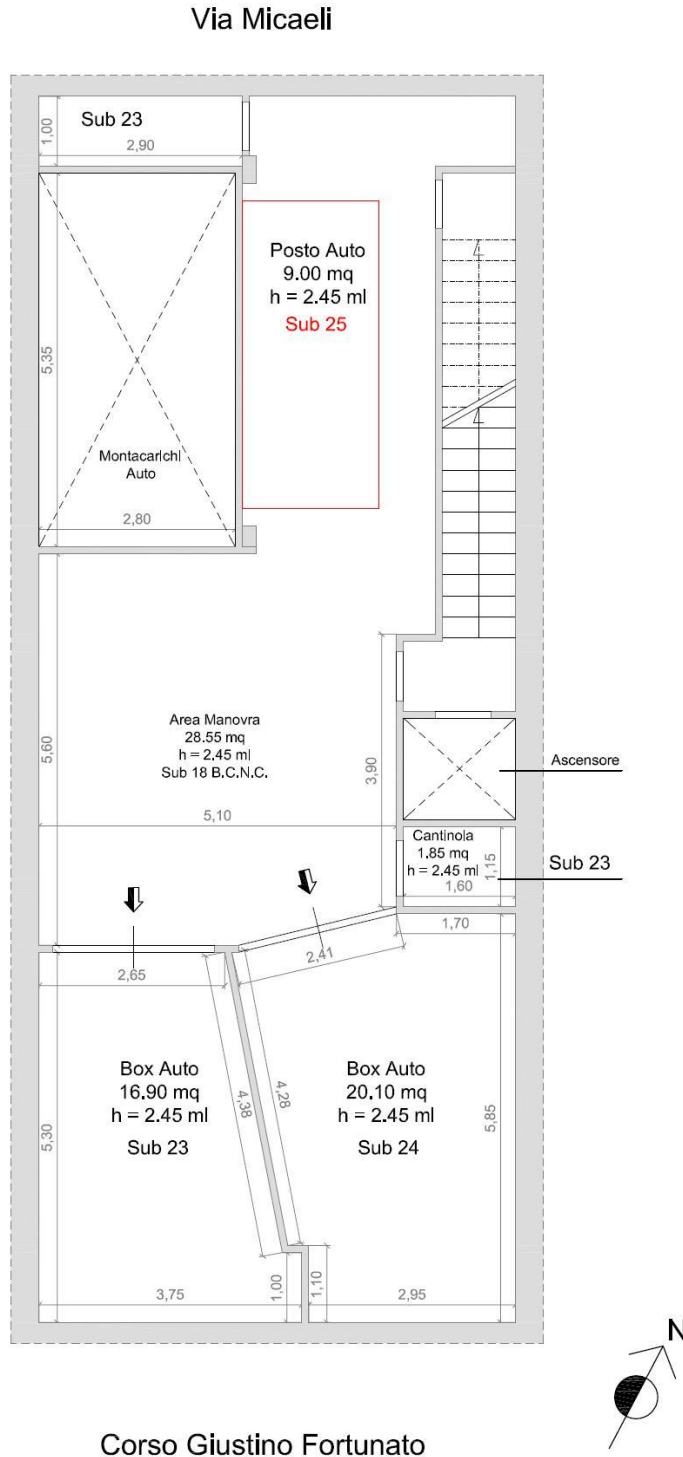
Planimetria Catastale Posto Auto Piano S1
